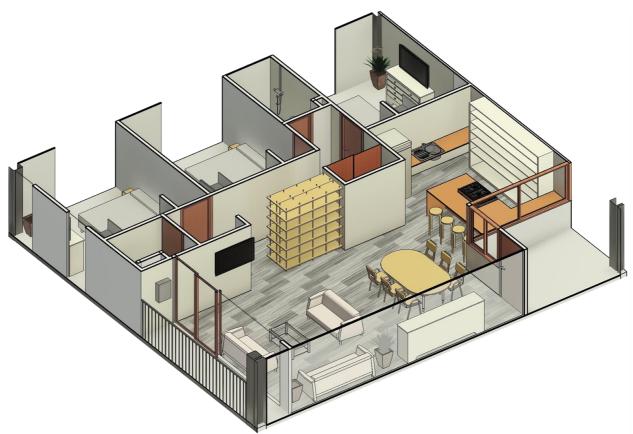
Propuesta final. Isométrico vivienda Sur oriente. Elaboración propia. 2022
